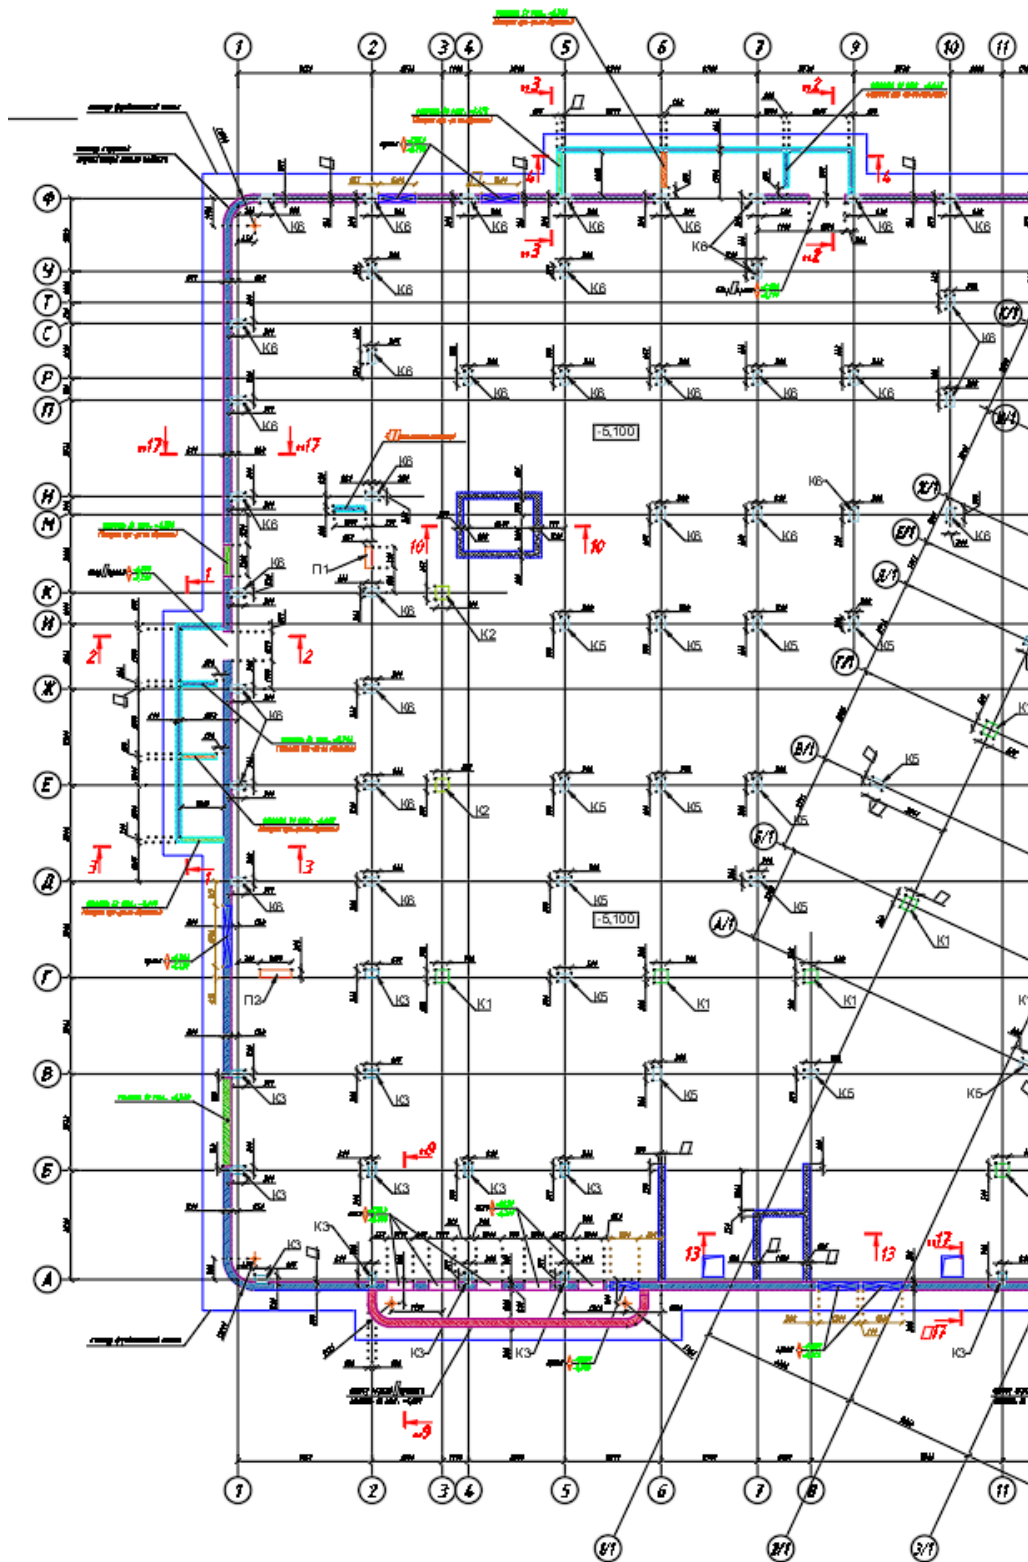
Схема расположения стен и колонн в осях 1-11. А-Ф
